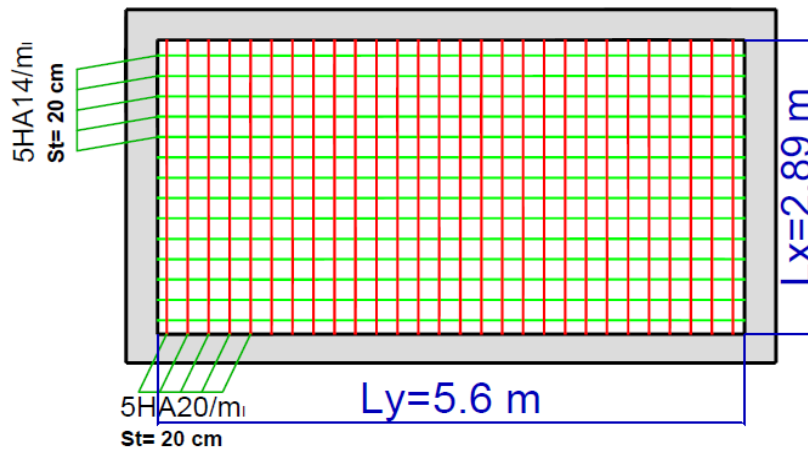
Schéma de ferrailage de la face tendue (intérieur du bâtiment) du voile périphérique
